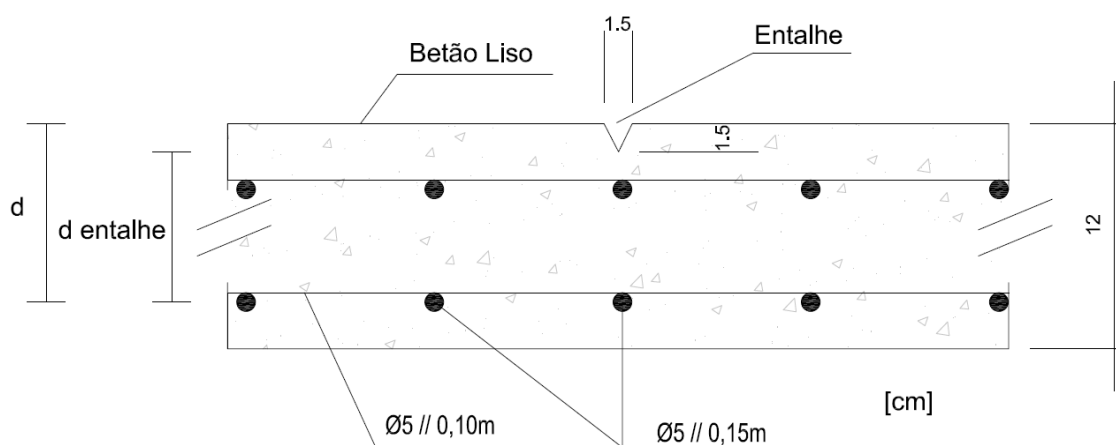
Alturas úteis das armaduras das placas de betão armado
